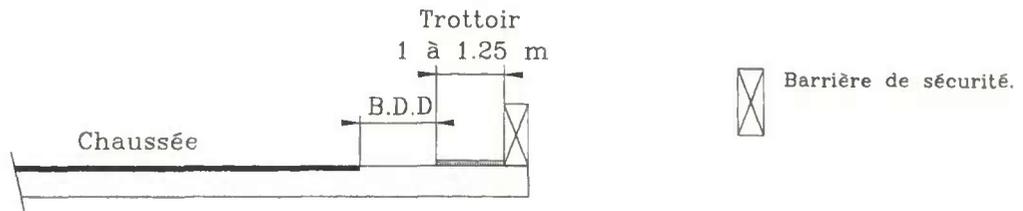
Dispositions types en présence de circulation piétonne au droit d'un trottoir non franchissable
